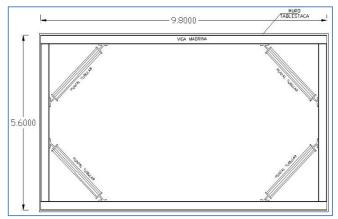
Planta de apuntalamiento en lumbreras.
